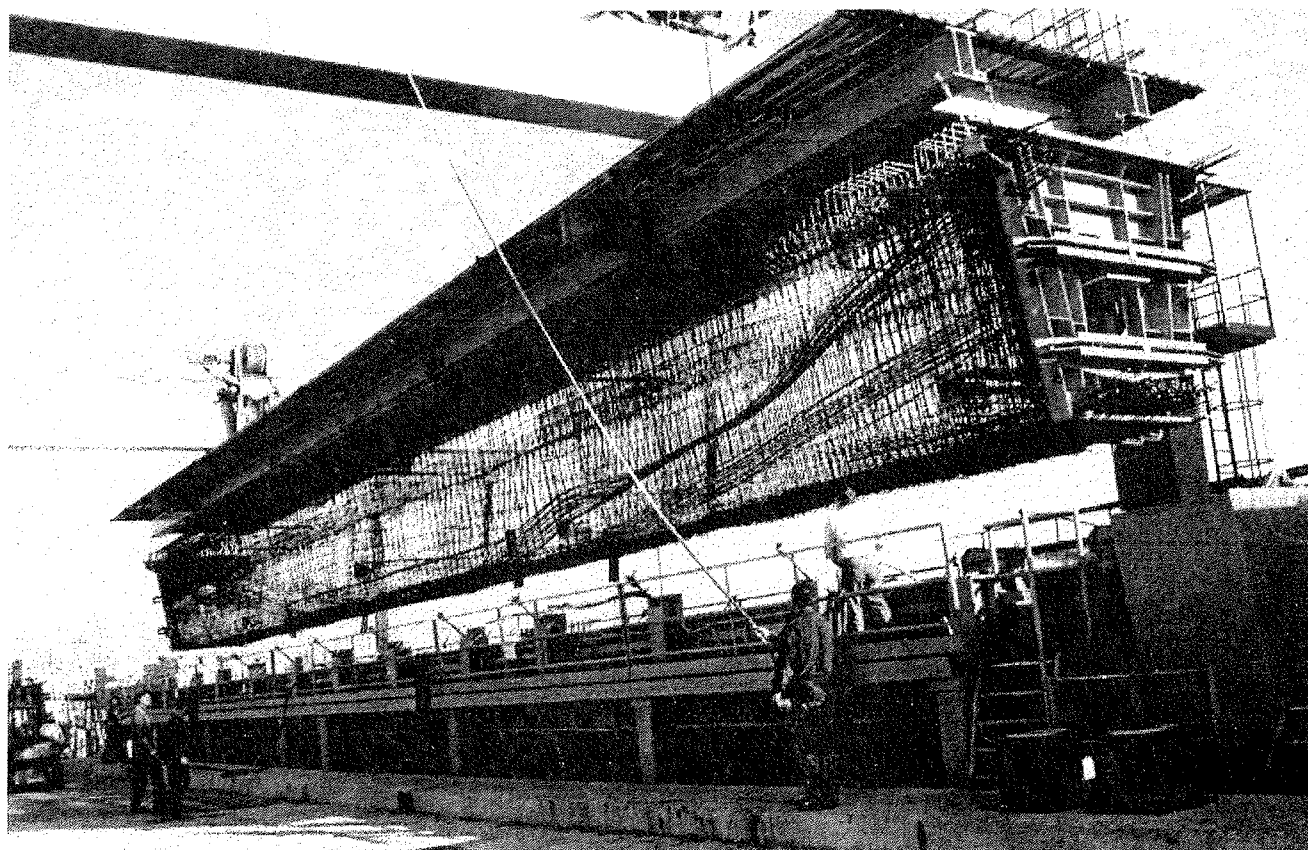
vista dal basso della gabbia di armatura in fase di posizionamento
